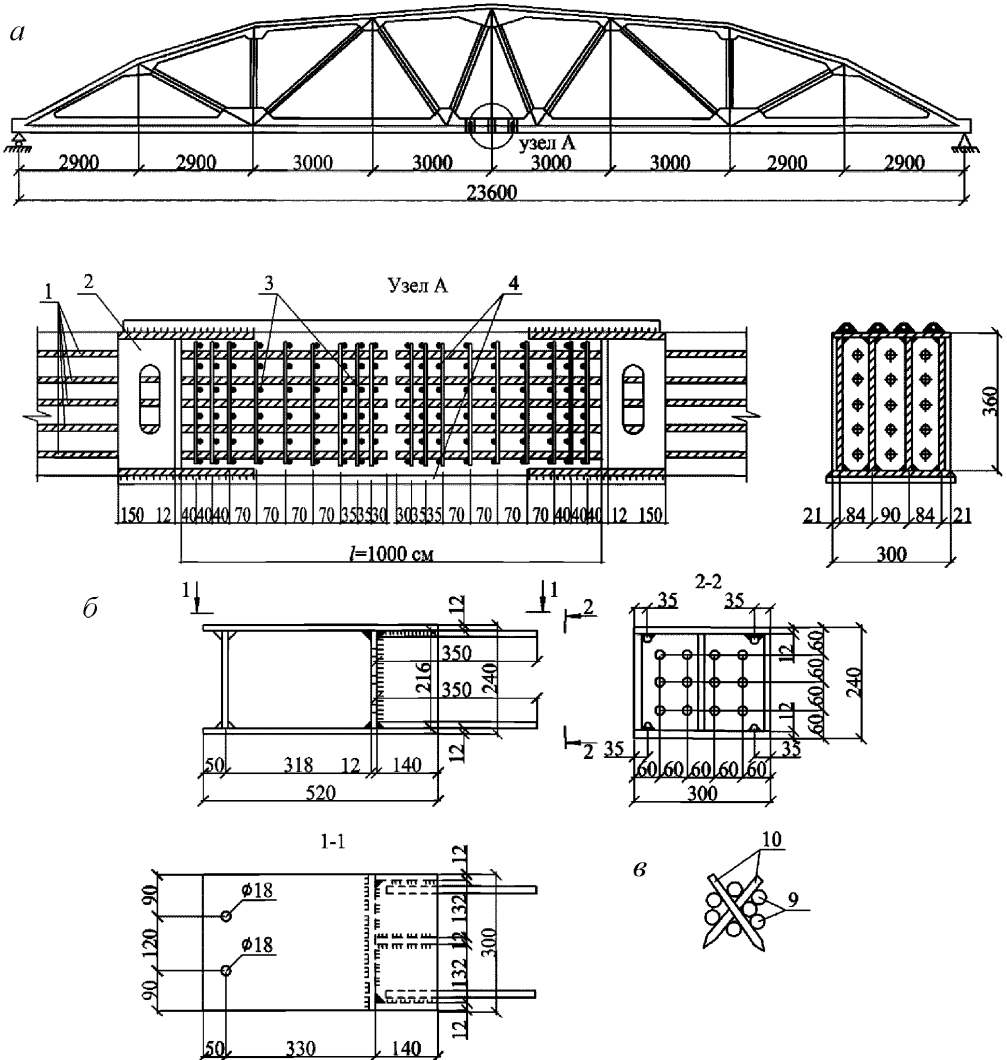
Стык растянутых элементов, армируемых несвариваемой и плохо свариваемой стержневой арматурой, натягиваемой на упоры
